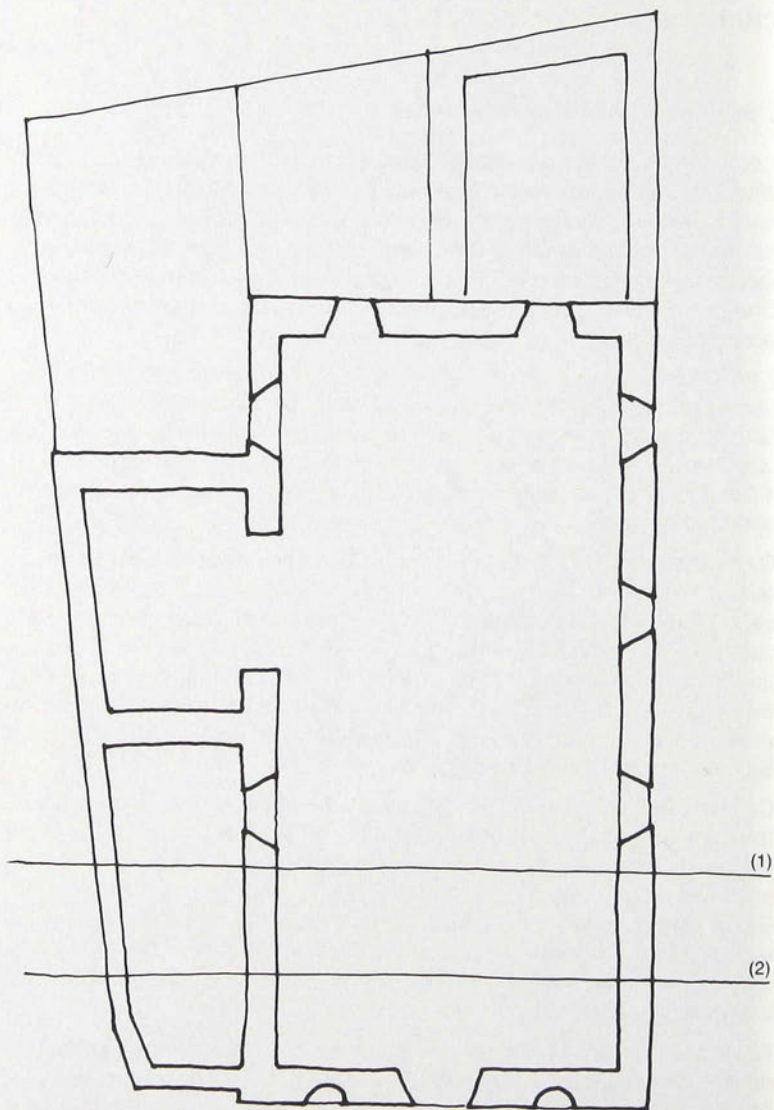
Plan après les travaux de 1723-1724: (1) les travaux en 1687 (2) les travaux en 1688.
